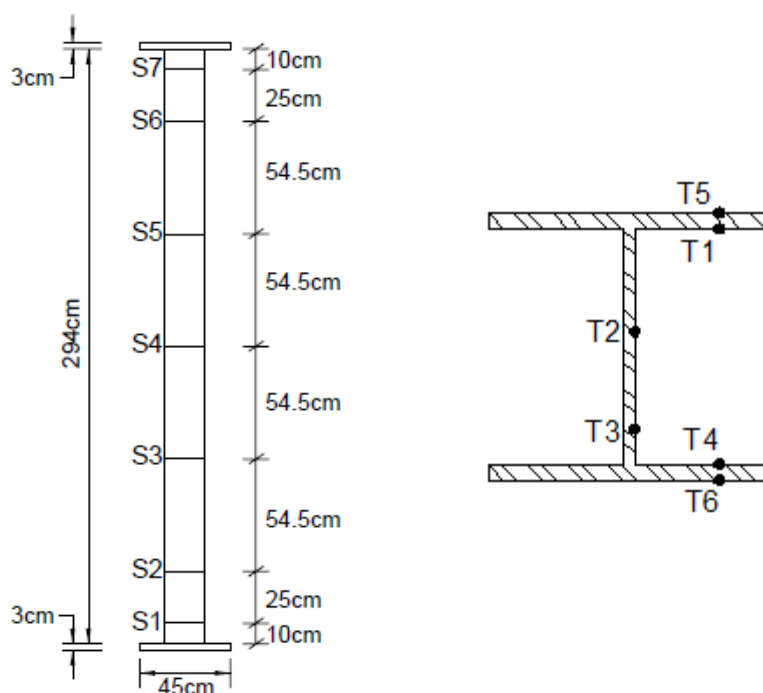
Posição das seções transversais definidas no perfil metálico e dos termopares instalados.
